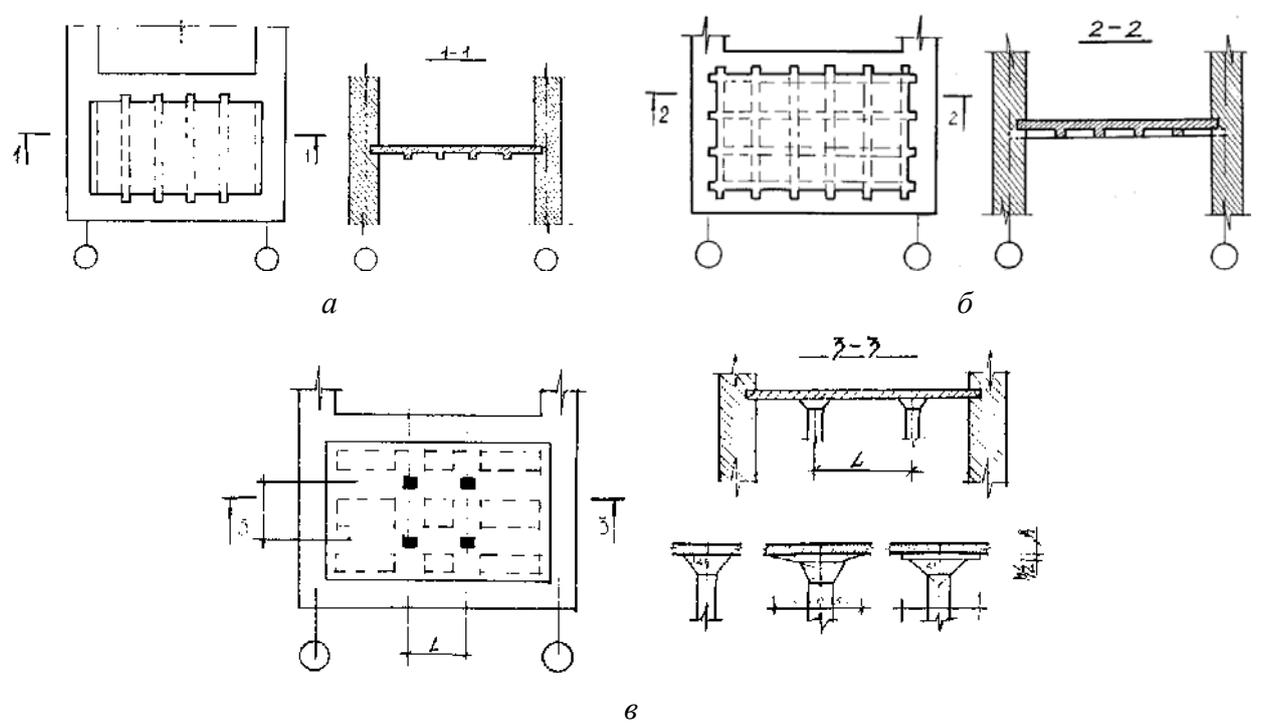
Монолитные железобетонные перекрытия: а — балочные; б — кессонные; в — безбалочные
